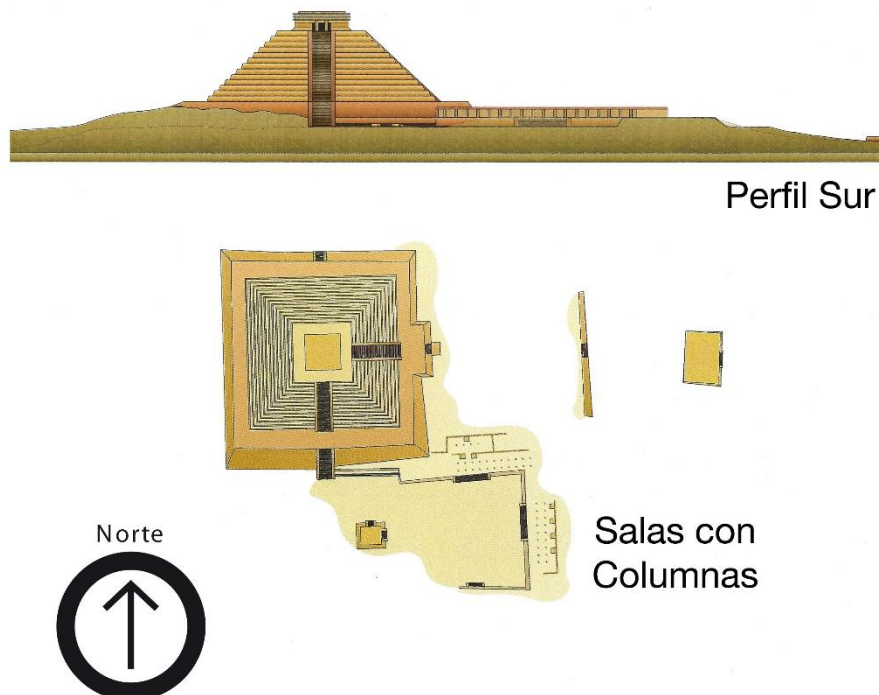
Fachada y planta arquitectónica sur. El Cerrito. Dibujo Daniel Valencia, INAH.
